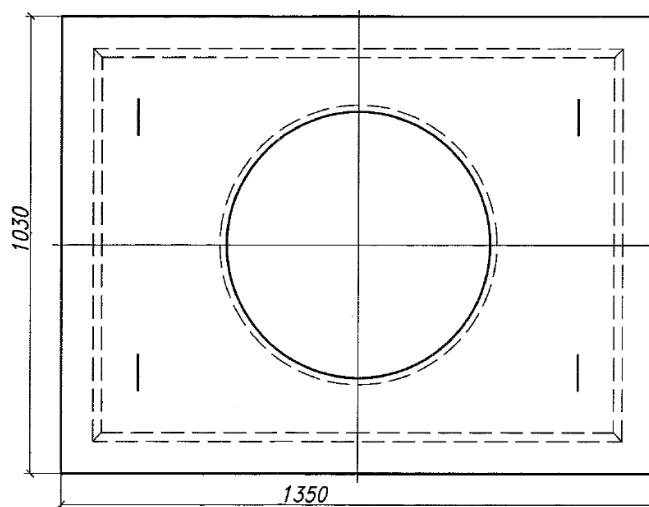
Расположение подъёмных петель на плите перекрытия (вид сверху).
